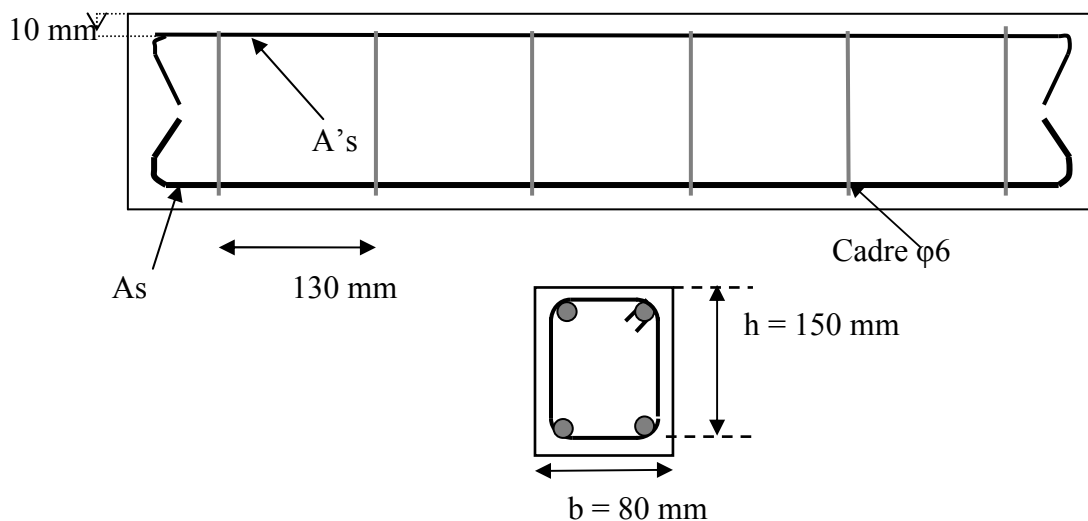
III.2 : Illustration des détails des poutres étudiées.
